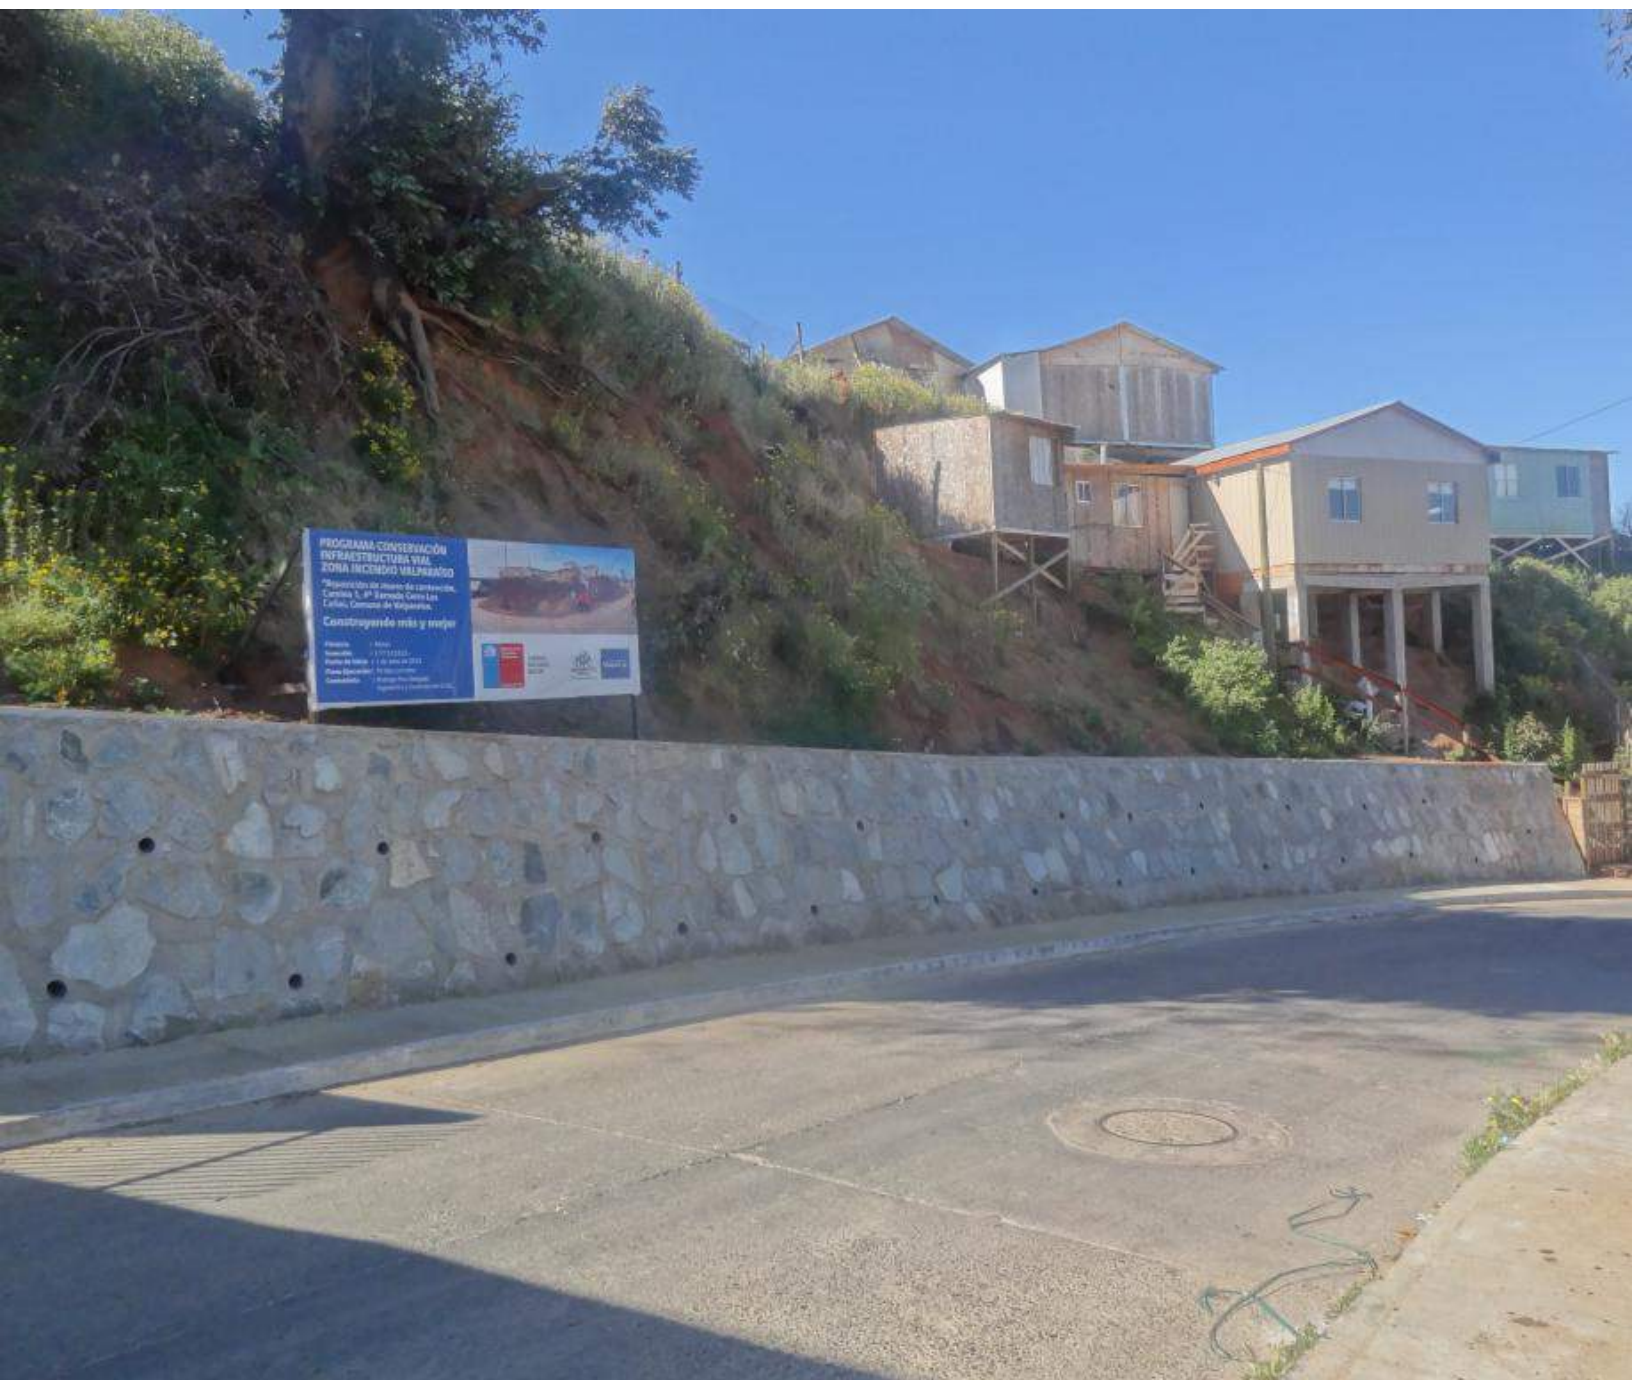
Ubicación de obras de infraestructura en ejecución- Cerro Las Cañas
